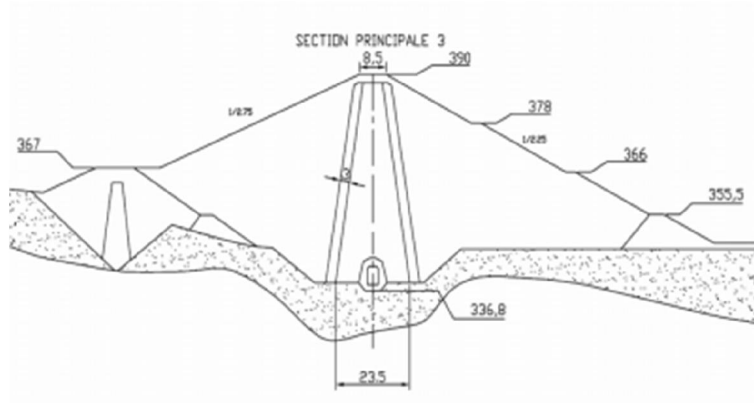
Le profil type du barrage (ANBT, 2004)
